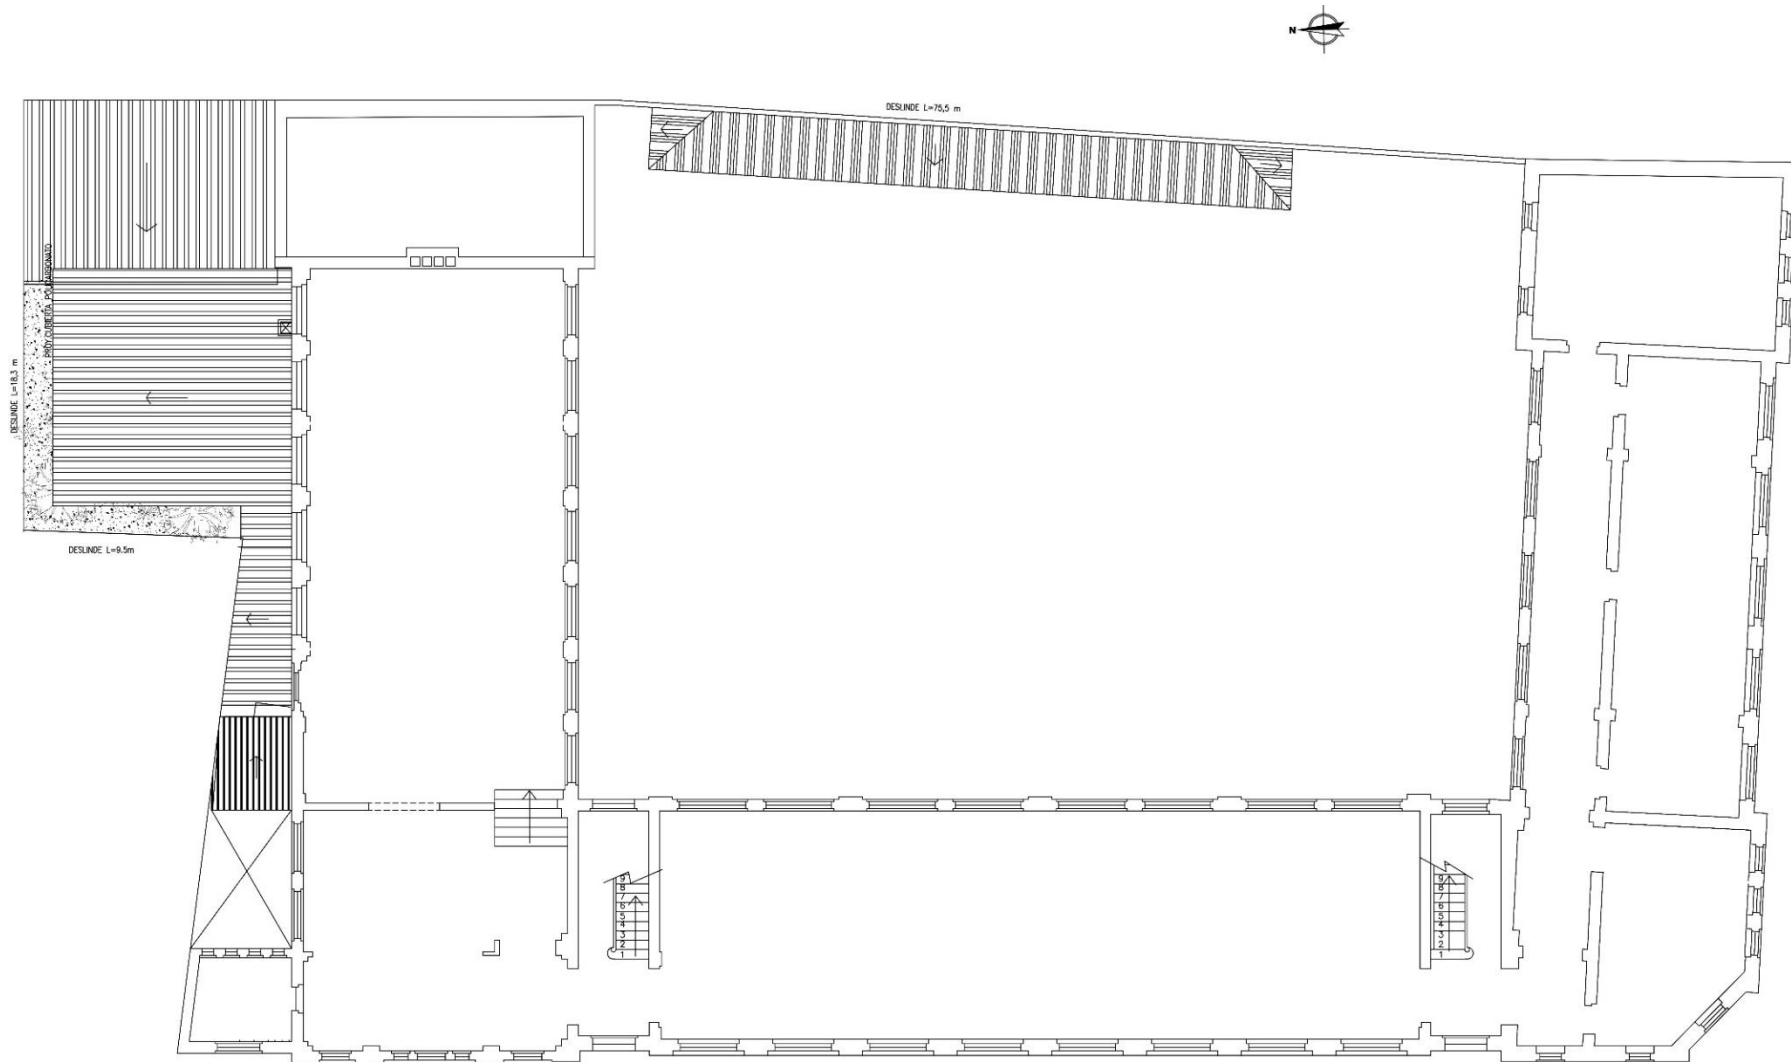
Planta Tercer Nivel previo a la intervención. Fuente: Elaboración Propia
